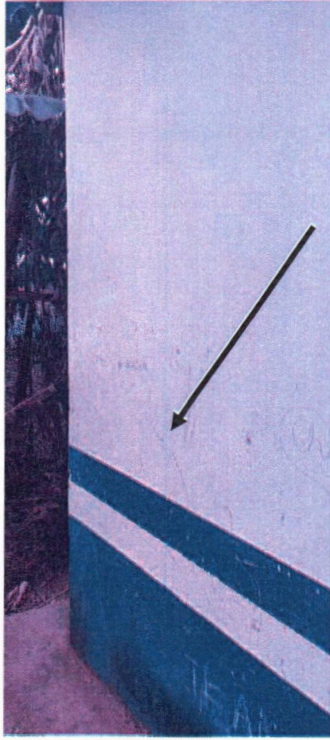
Identificação de fissura em 45° oriundas do solo, ocasionando descolamento da alvenaria em área externa da escola.
